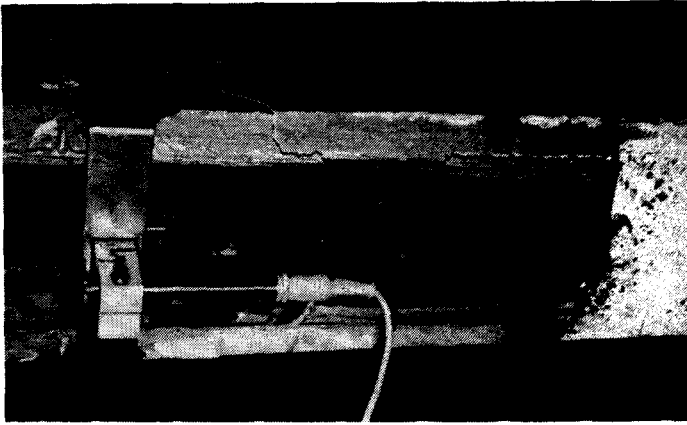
Typisches Bruchbild eines Laschenkörpers
